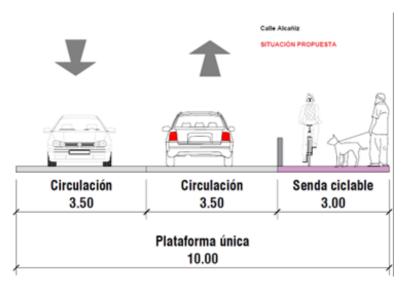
Alternativa 3 propuesta en la C. Alcañiz. Fuente: DOYMO
